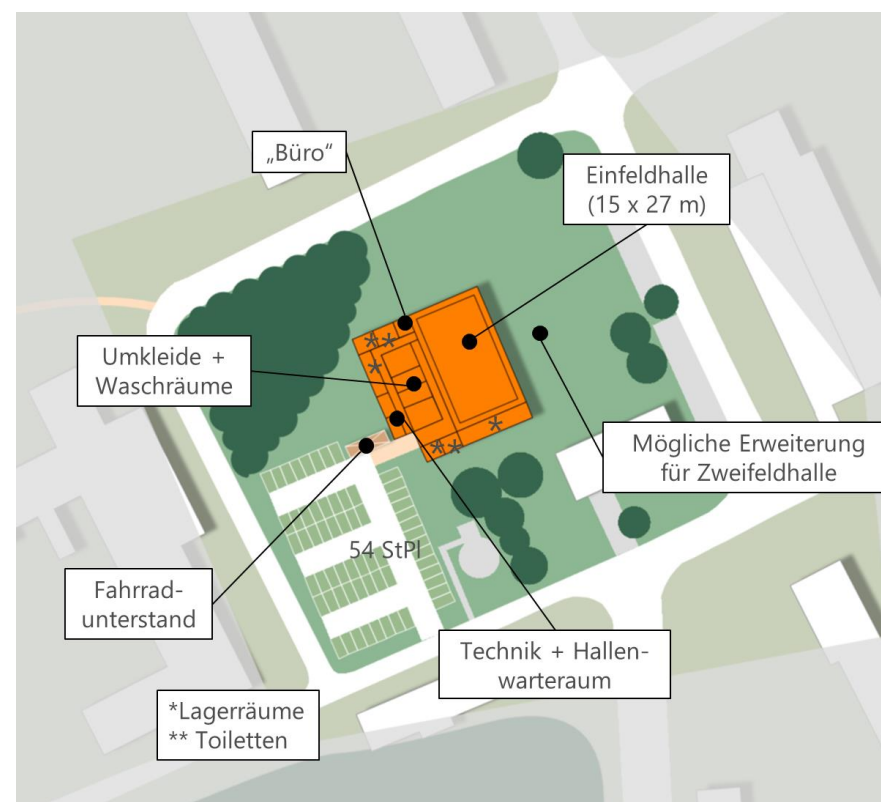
Städtebaulicher Testentwurf der neuen Mehrzweck- und Sporthalle (CIMA 2023)
